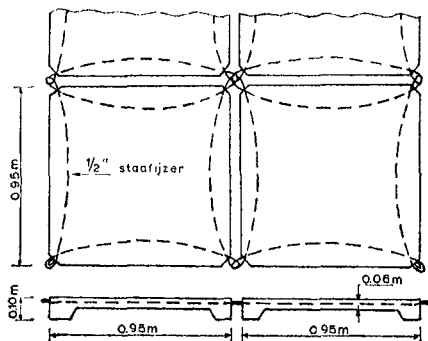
Elementen van een betonnen zinkstuk systeem „de Muralt”.
